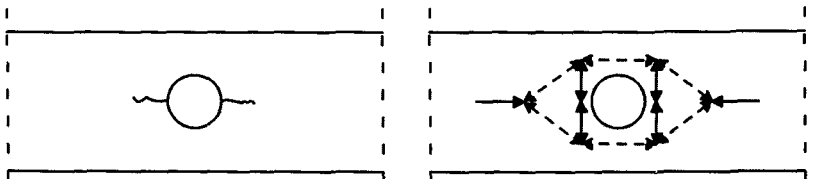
Horizontalriss und zugehöriges Stabwerkmodell im Aussparungsbereich
